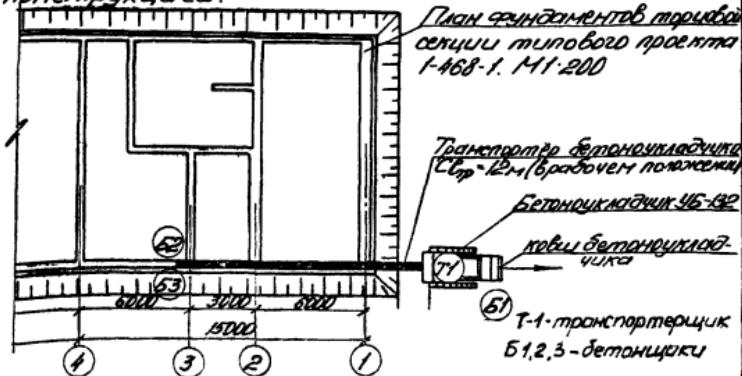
Схема организаций рабочего места при бетонировании фундаментов торцовой секции 1-468-1
